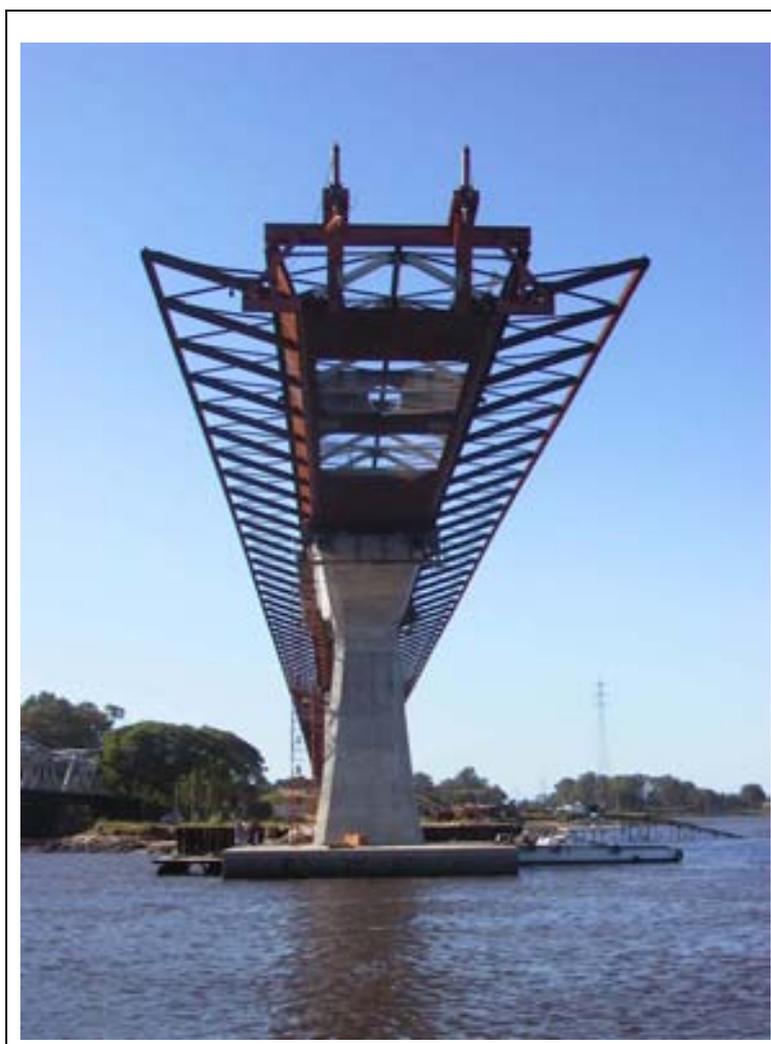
Vista frontal del Ábaco (durante el Lanzamiento)
